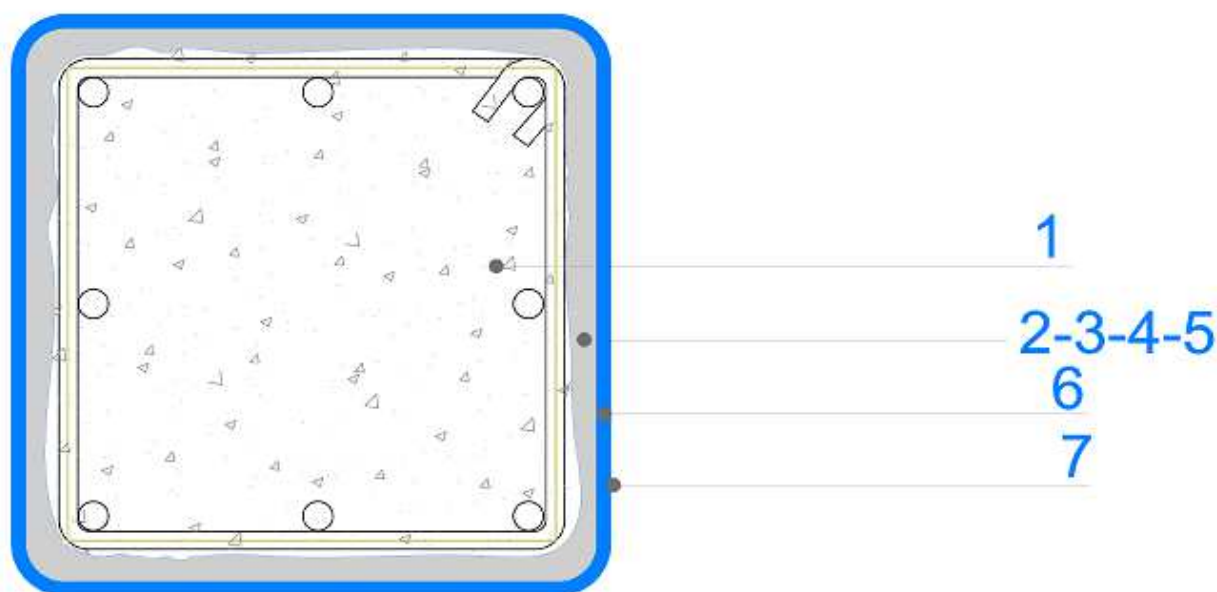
Sezione tipo di rinforzo a taglio pilastro mediante FRP
